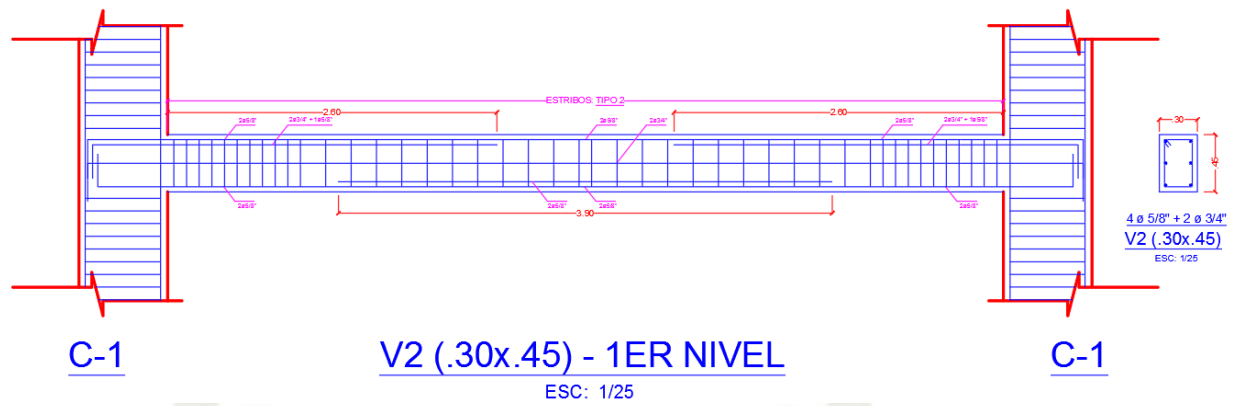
Dibujo del diseño por flexión, corte y torsión de la V2 del primer piso (Elaboración propia)
